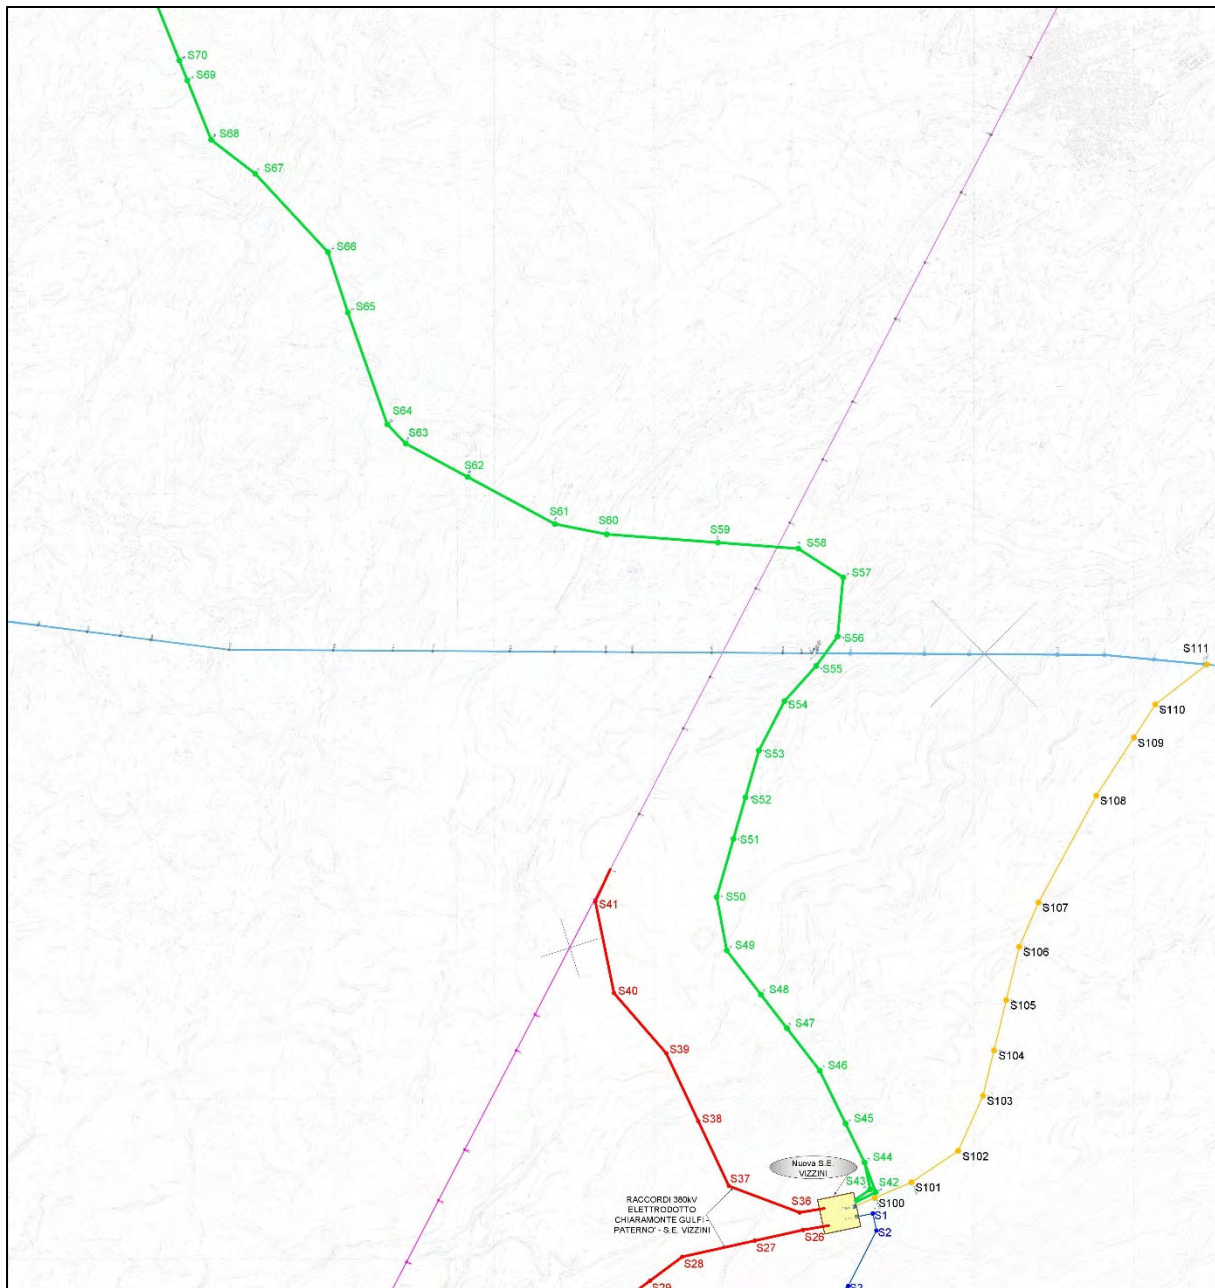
Planimetria con ubicazione prelievi linee foglio 03\_2
